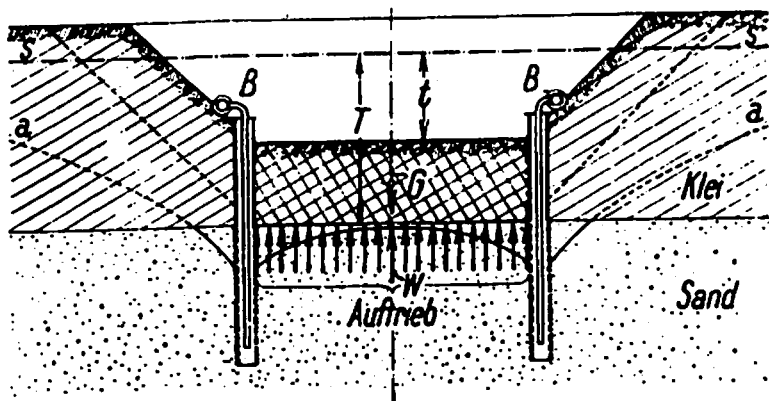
Beseitigung einer Kleischicht unter dem Schutze einer Grundwasserabsenkungsanlage. Darstellung der Baugrubentiefet, bei deren Erreichung die Brunnen in Betrieb genommen werden müssen.
